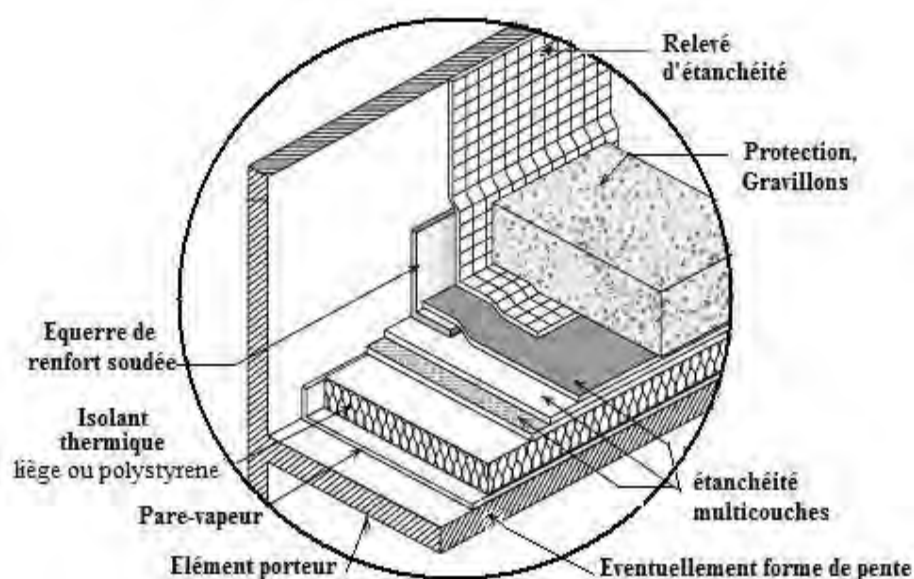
Composition du revêtement d'étanchéité des toitures-terrasses.
